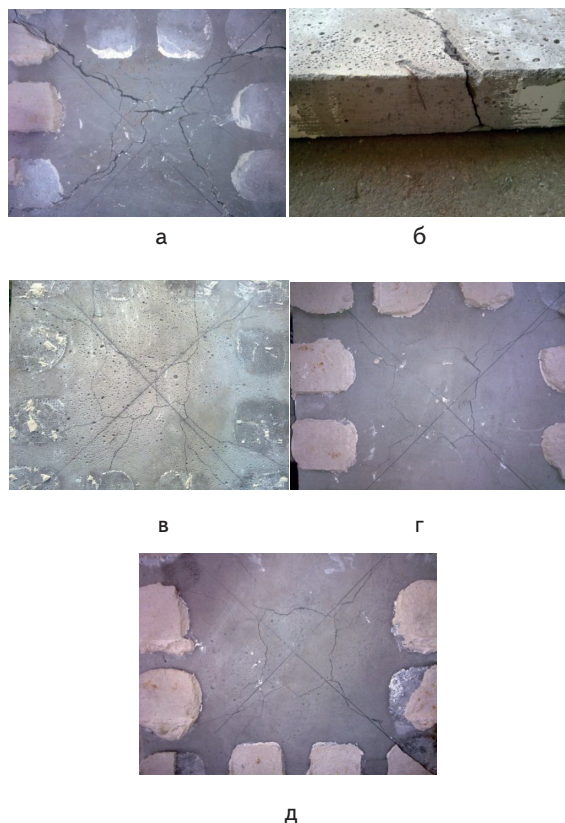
Вигляд зруйнованих плит (розтягнутого шару): а та б – плита сталевібробетонна (ПСФБ), в – плита сталевіброзалізобетонна комбіновано армована (ПСФБК); г – плита сталевіброзалізобетонна двошарова (ПСФБД); д – плита залізобетонна (ПЖБ)
